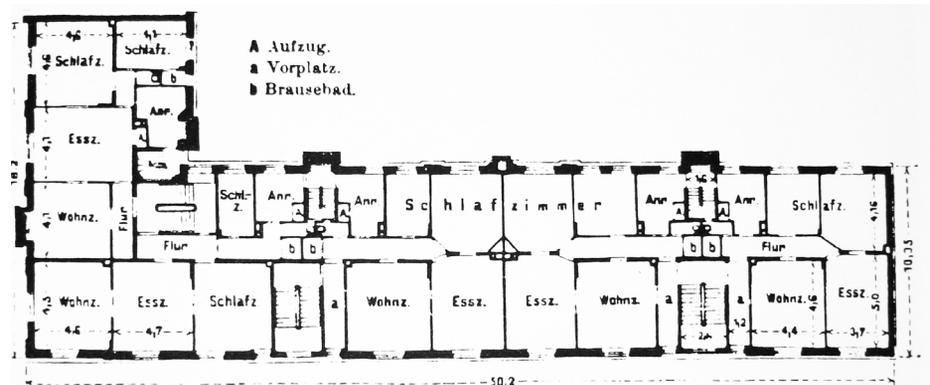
Service House, Kopenhagen, Grundriss 1906
